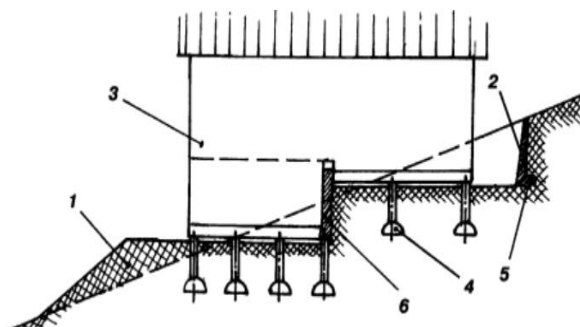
Устройство двухуровневой строительной площадки на склоне:
